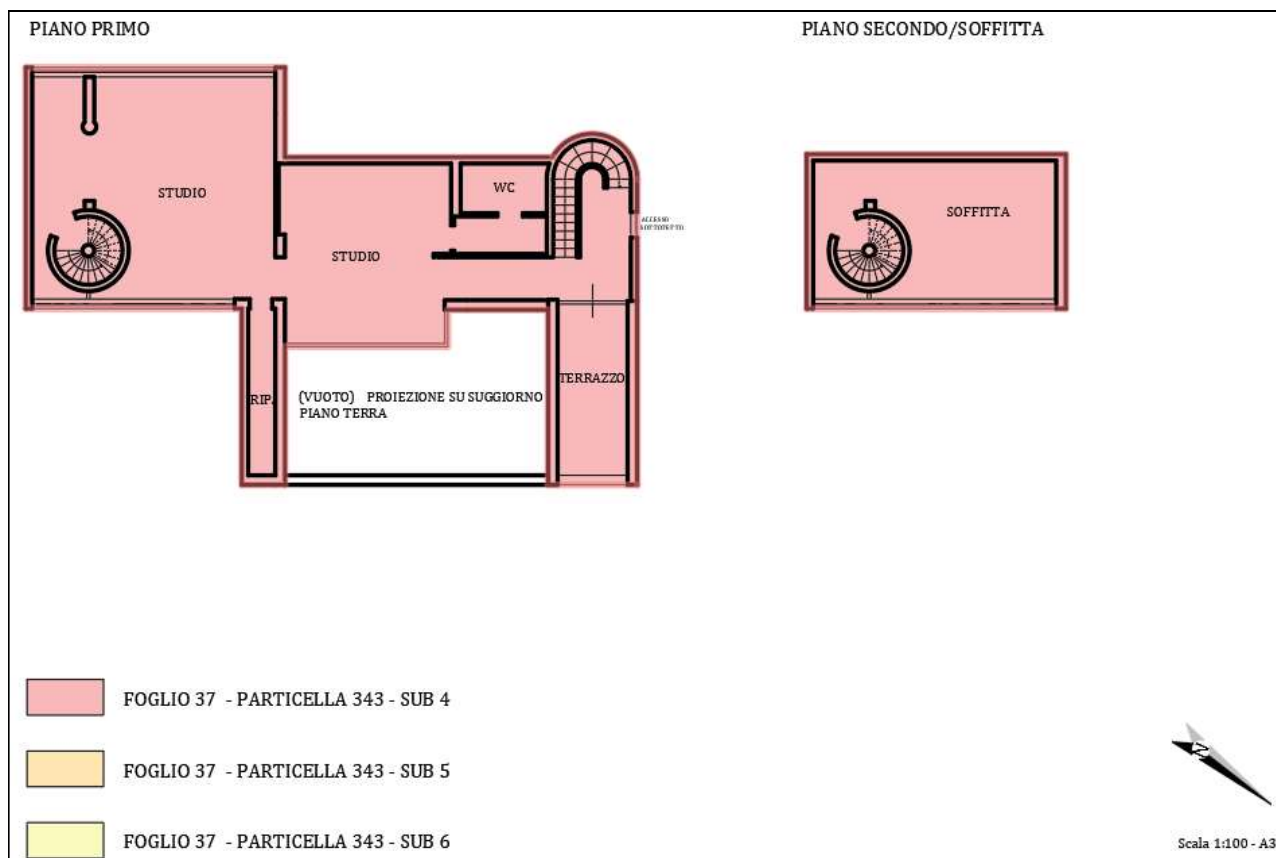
Planimetria dell'immobile – Piano Primo e piano secondo/soffitta
